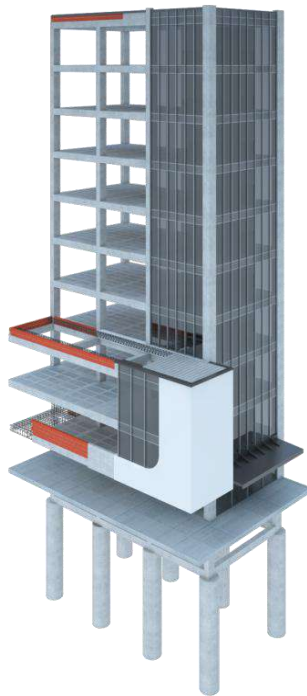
sistema constructivo ferro concreto moderno tardío, edificios en altura - Caja Social
